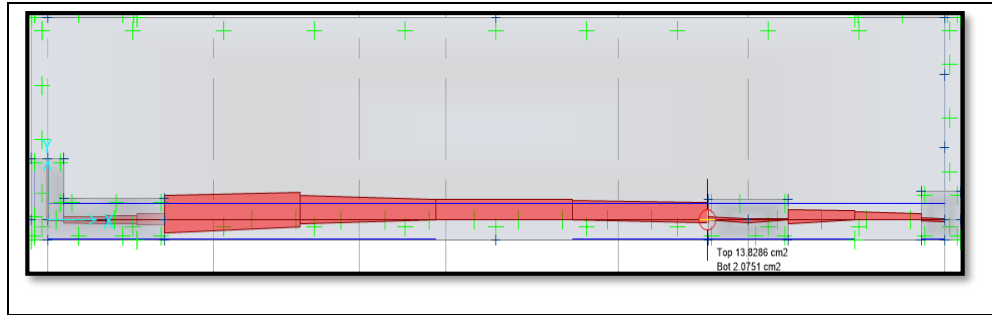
Detalle del acero longitudinal en la viga de cimentación VC 101 de 30x70.
